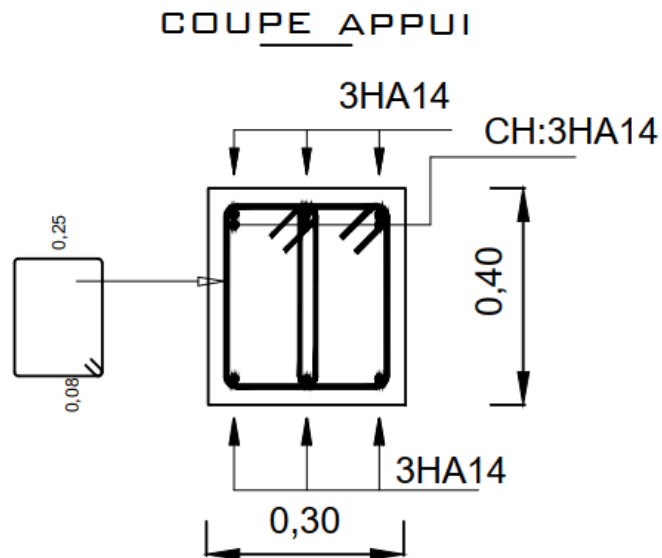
Ferraillage de la poutre secondaire sur appuis
